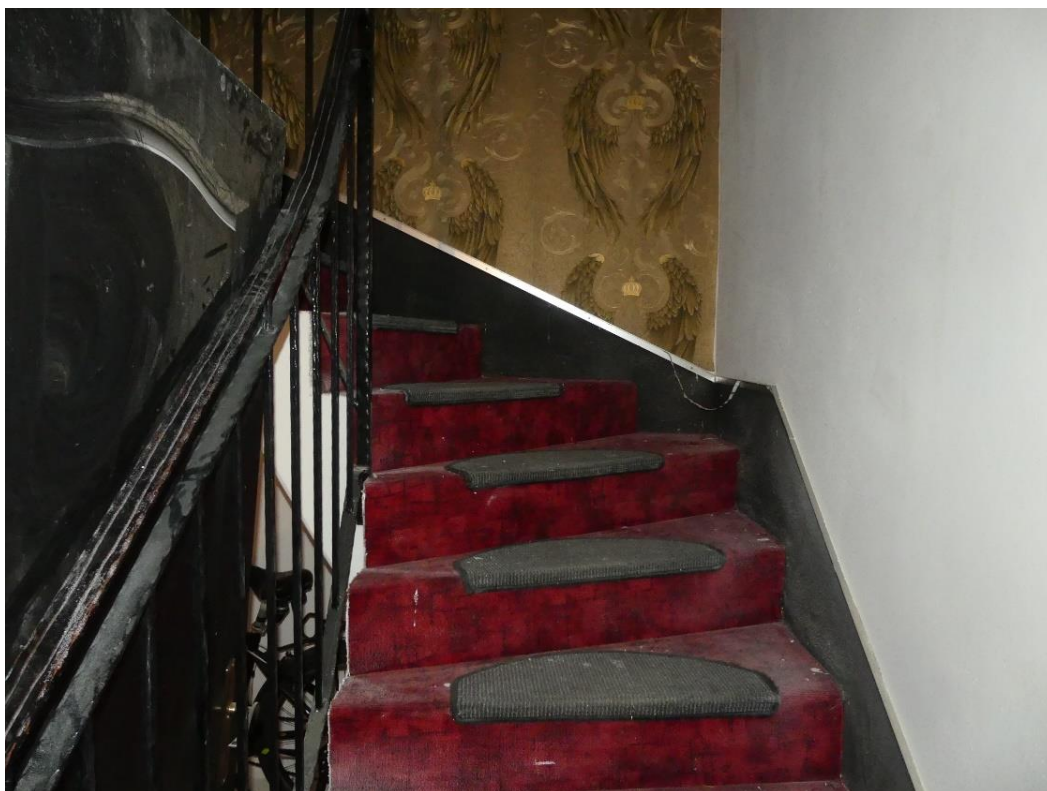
Treppe ins Obergeschoss Döbelner Straße 25 a
